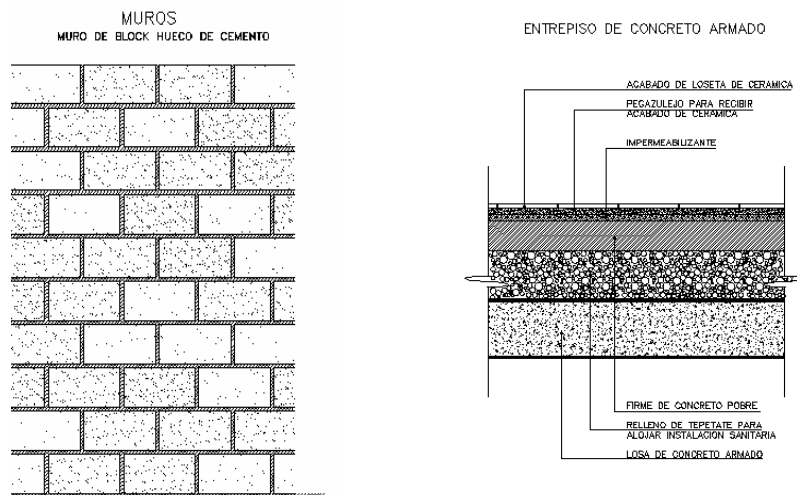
Muros y Corte del Entretecho de la Vivienda Tipo.
